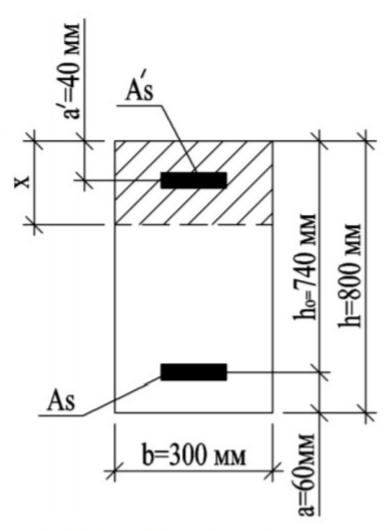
Прямоугольное сечение элемента с двойной арматурой
